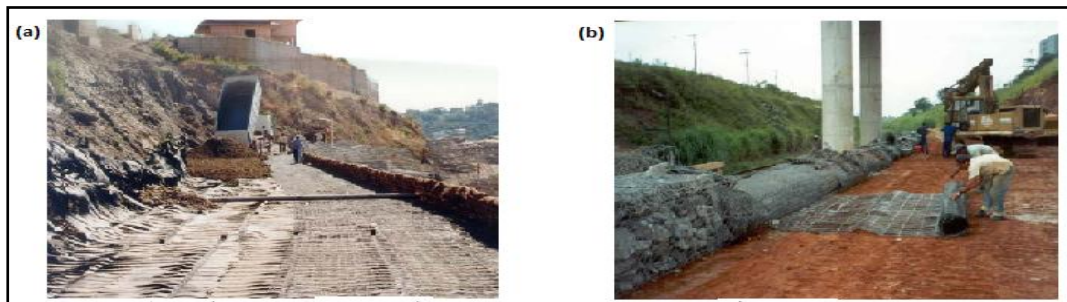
Structure en renforcement mixte : (a) illustration de la construction, (b) détail d'installation des géogrilles
